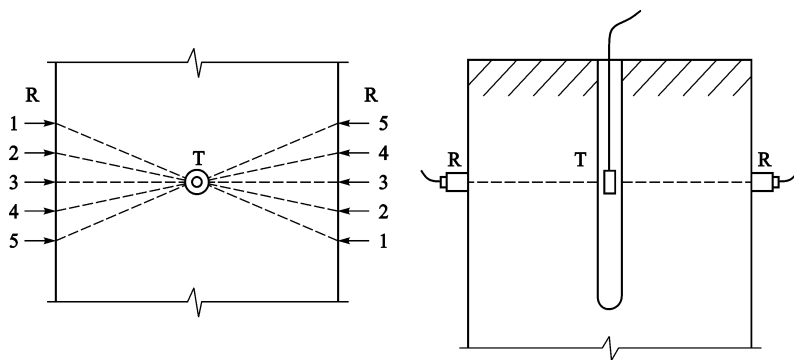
混凝土缺陷检测钻孔法测点布置
